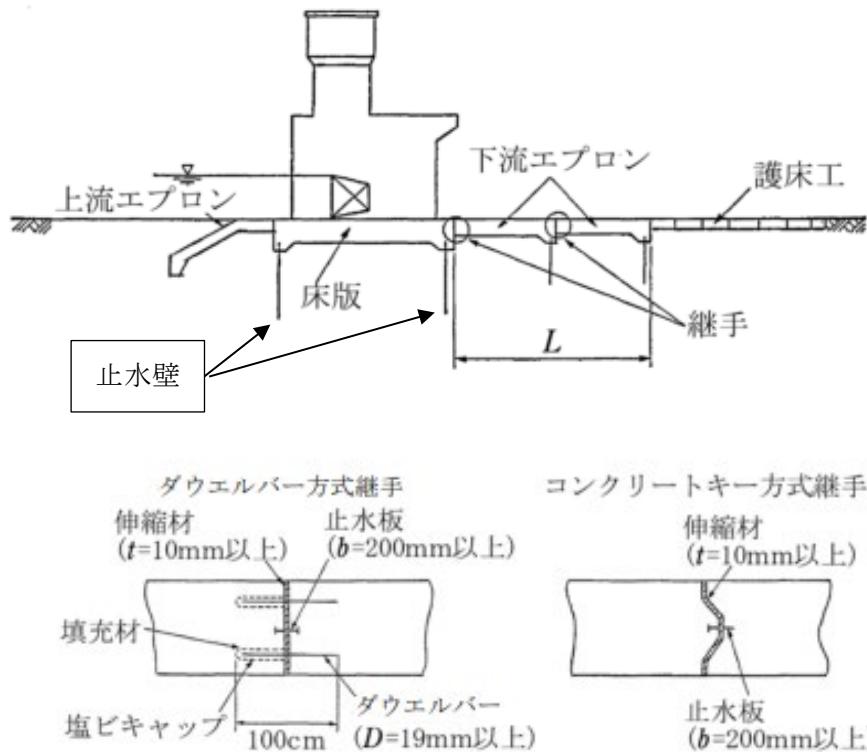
基礎の詳細図（止水壁の概要及びエプロンの継目詳細図）
